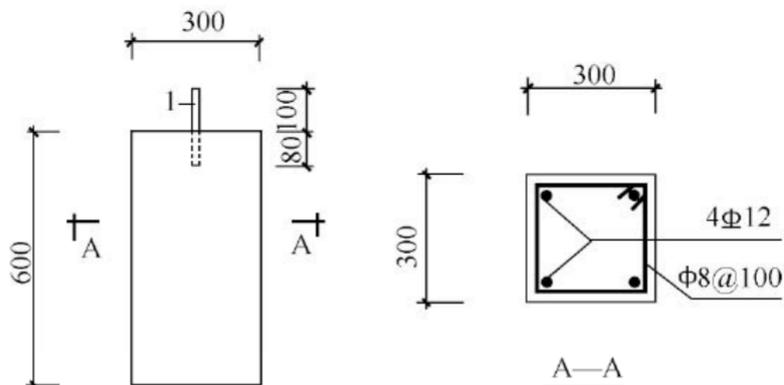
1 种有螺杆的试件 (单位 mm)
